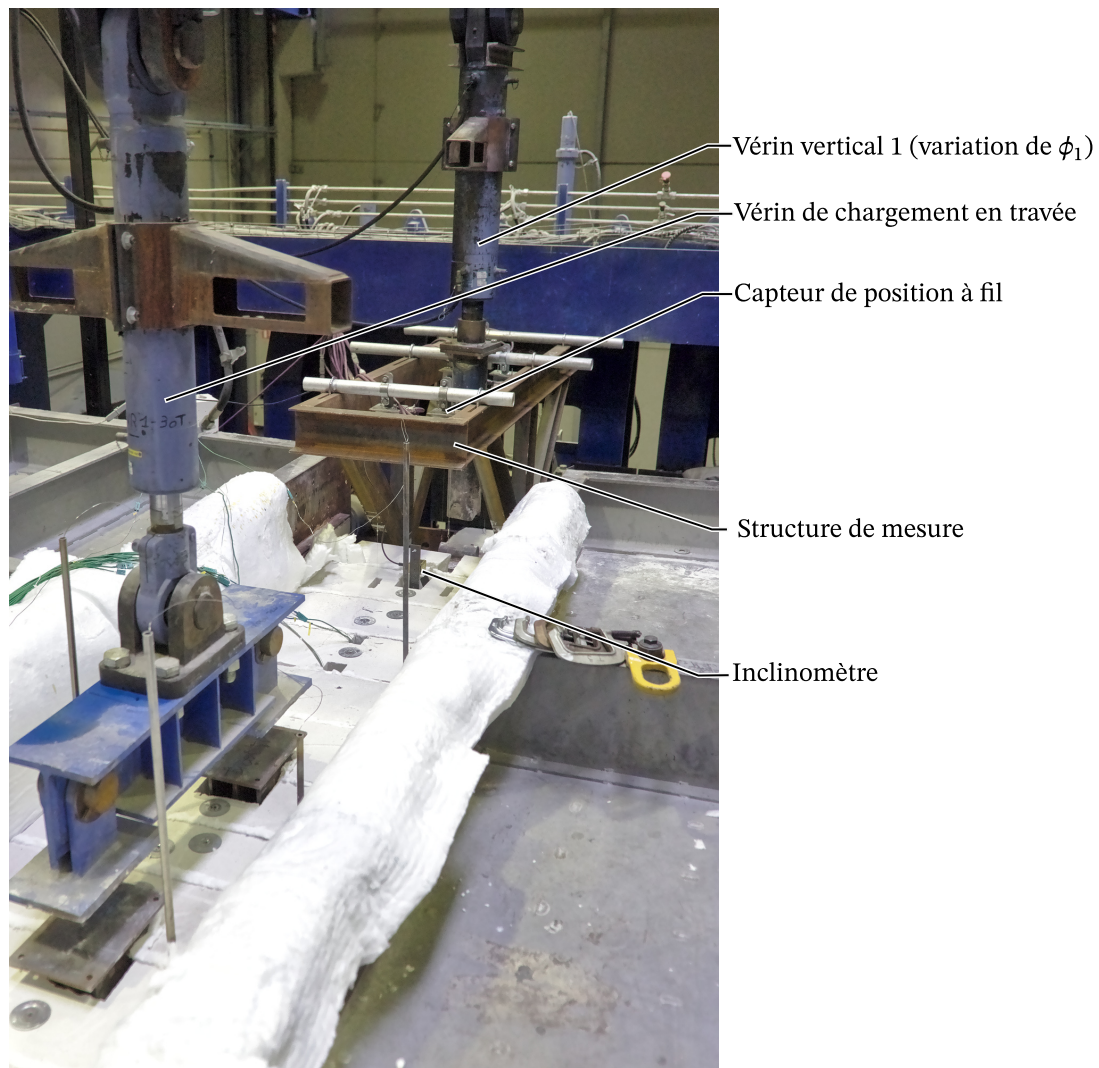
Vue du dessus de la partie gauche du dispositif.
